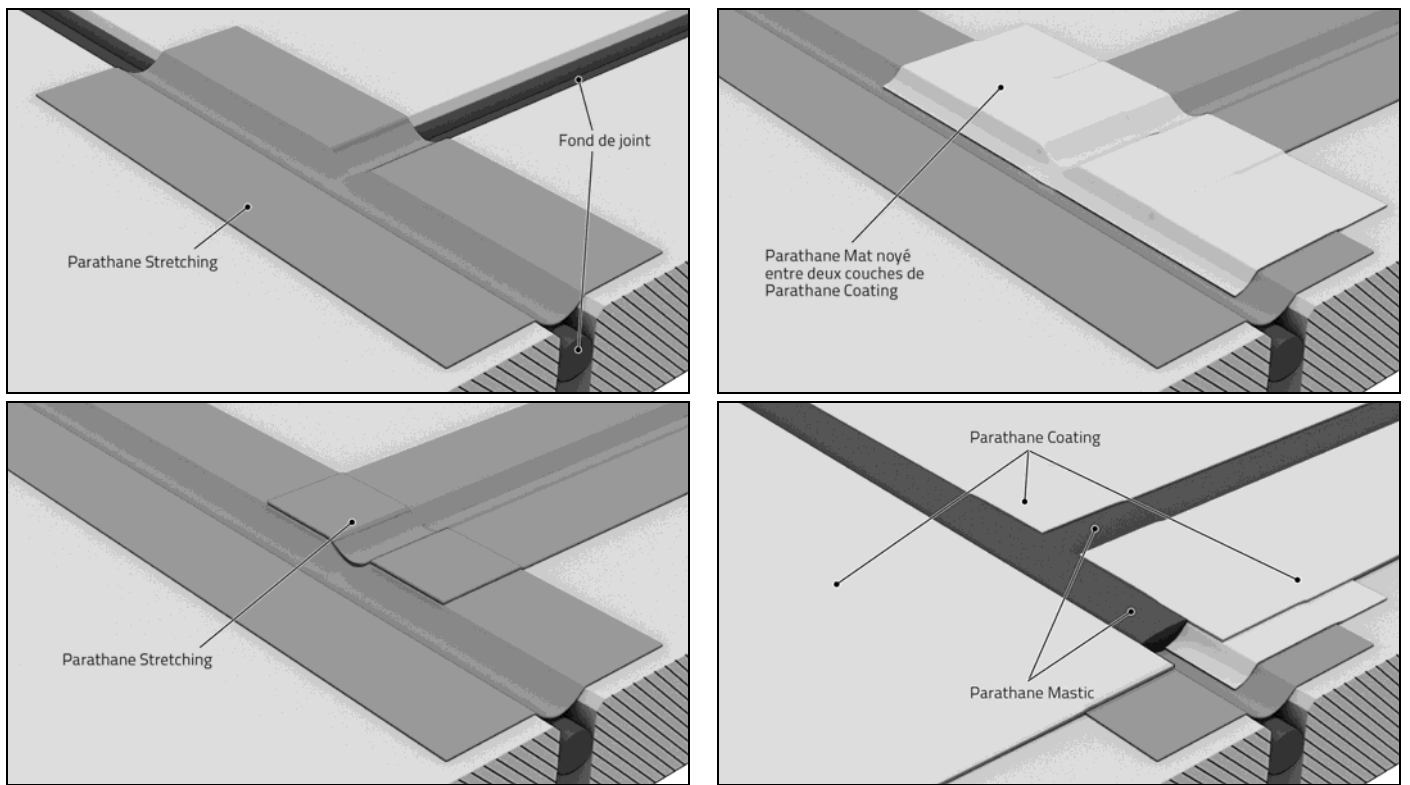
bis - Joint de dilatation sur costière pour terrasse inaccessible, technique, accessible avec dalles sur plots
